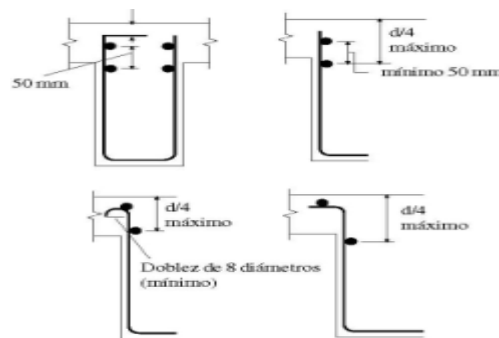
Anclajes e estribos U de refuerzo electrosoldado de alambre liso en la zona de compresión
